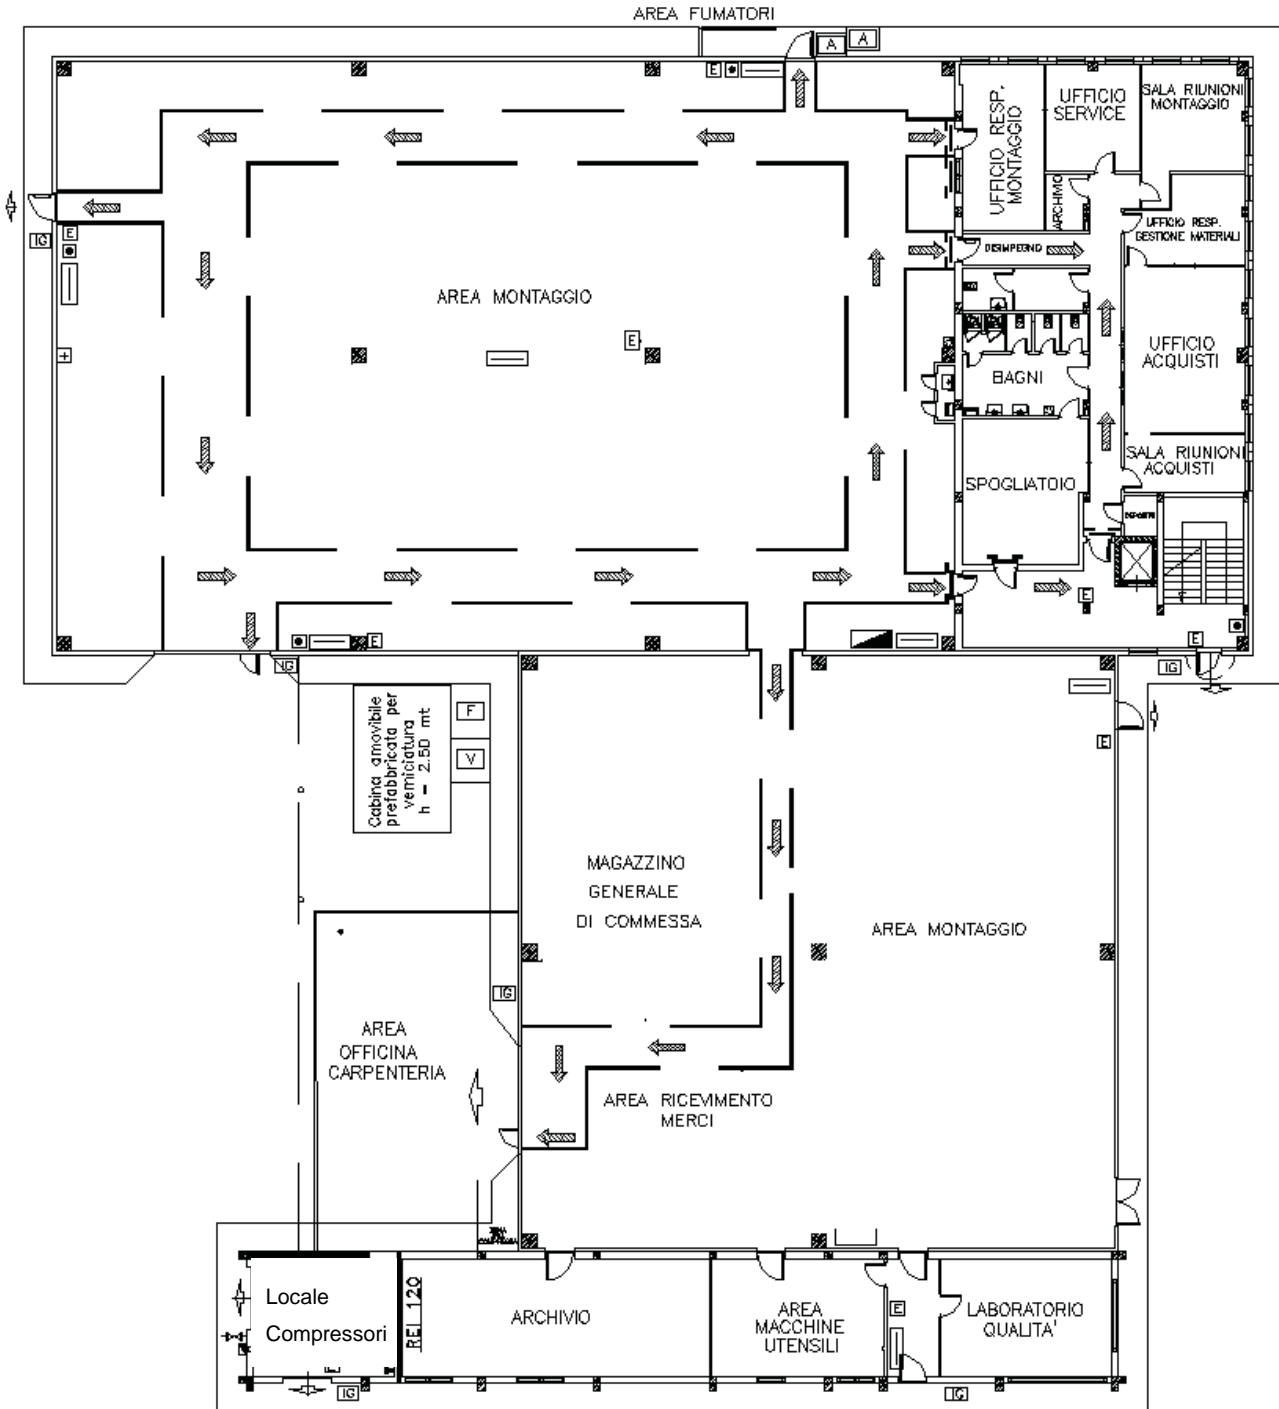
Planimetria zone montaggio officina e uffici piano terra, palazzina nuova
